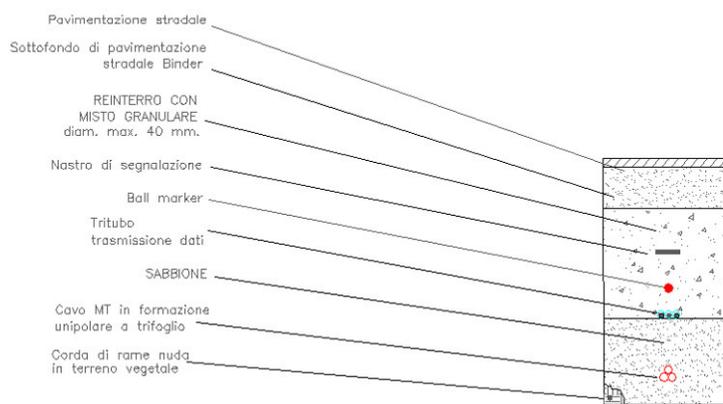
Particolare Posa del cavidotto all'interno del manufatto stradale
